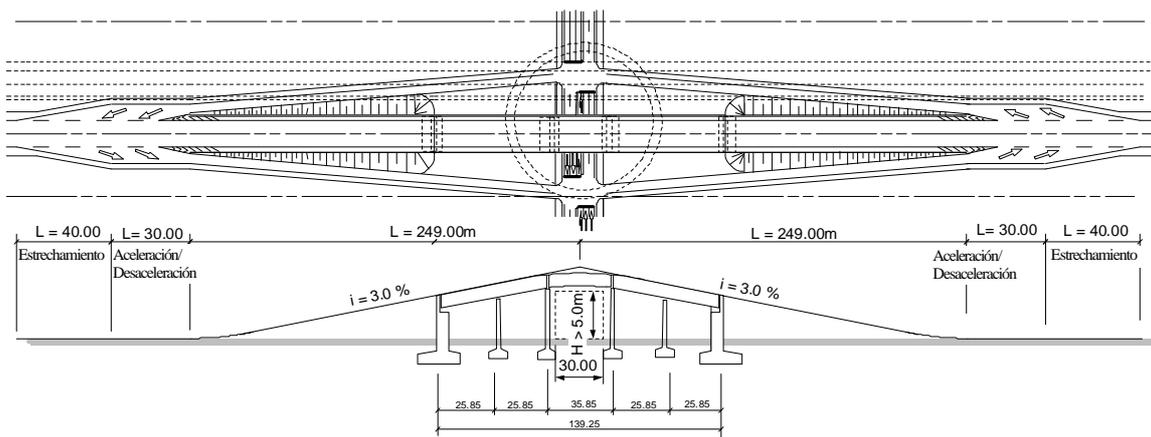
Plan para Separación de Nivel de la Intersección en Coronel Oviedo
